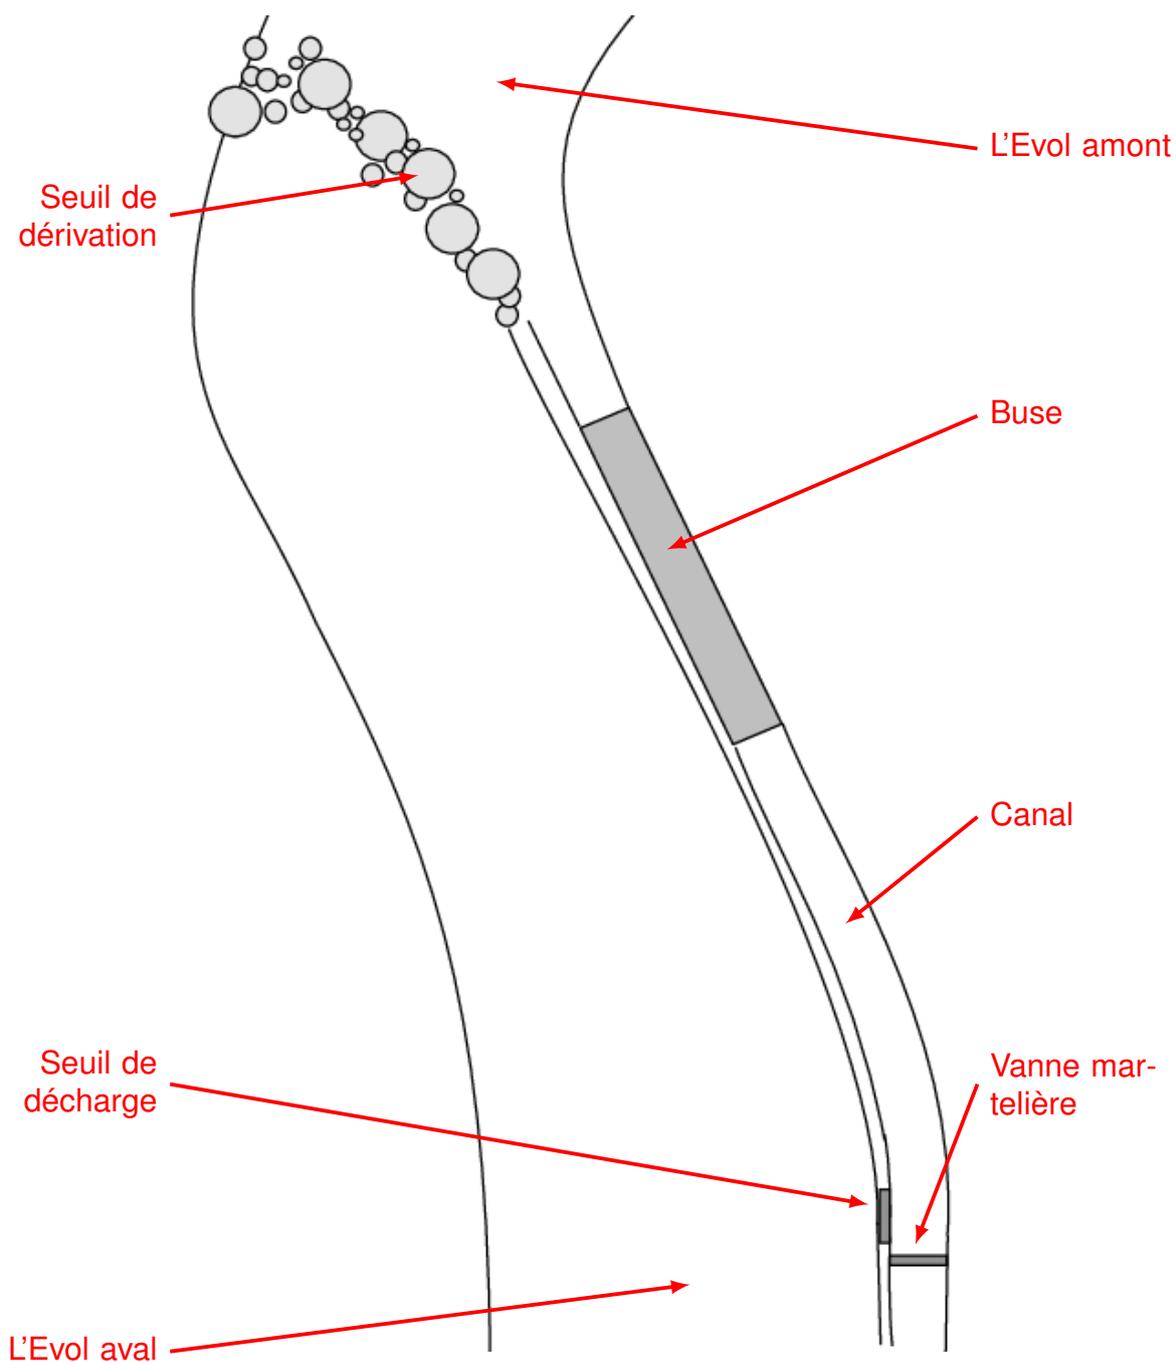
Plan de la prise d'eau Canal d'Évol ©IGN
